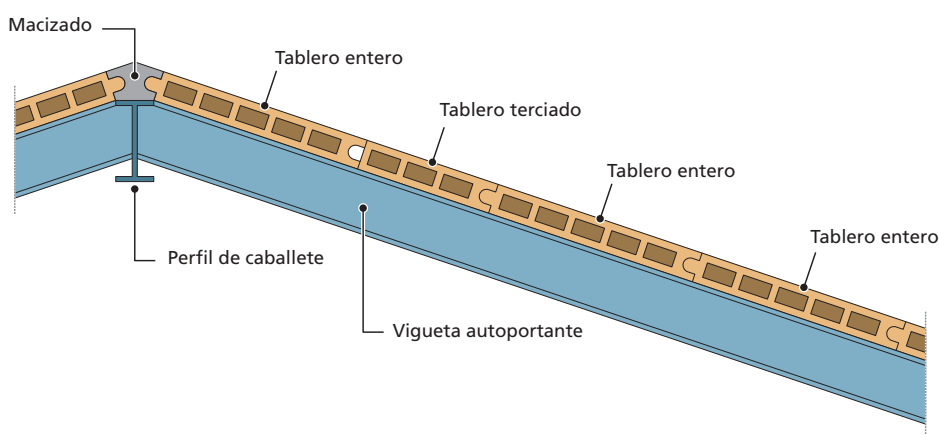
Apoyo del tablero en encuentro con elemento sobreelevado en cubierta sobre viguetas autoportantes de hormigón
